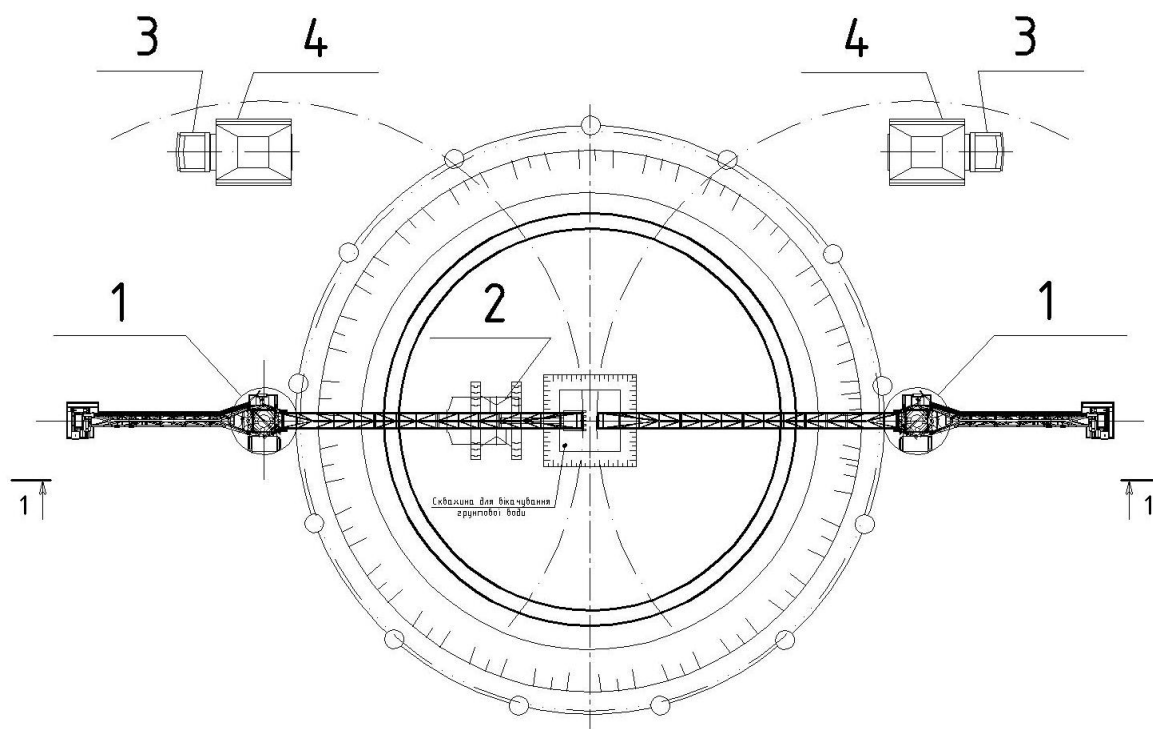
Схема бетонування стін колодязя: 1 – баштовий кран; 2 – авто бетонозмішувач; 3 – бадді; 4 – віброхобот; 5 – приймальна лійка; 6 – опалубка; 7 – інвентарні підмості
